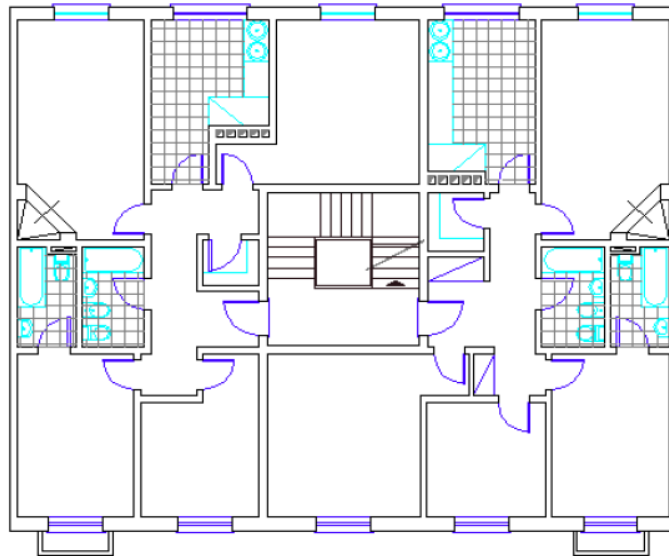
Planta arquitetónica dos pisos correntes (Moutinho, 2015)
